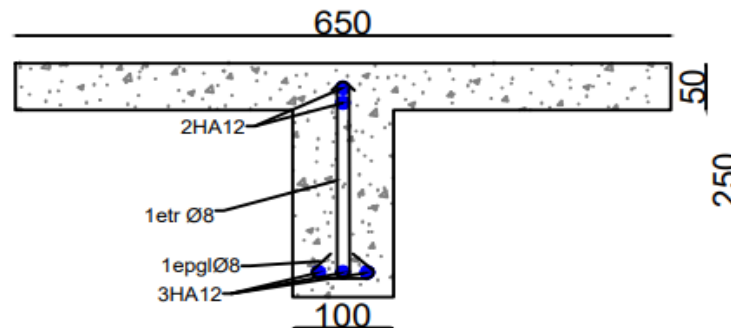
Le ferrailage des poutrelles en travée et en appuis intermédiaire.
